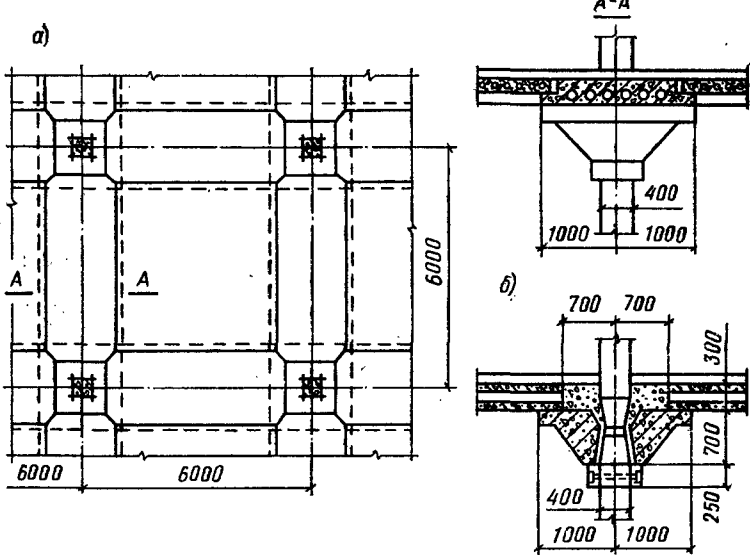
Конструкция безбалочного сборного перекрытия с пустотными панелями
